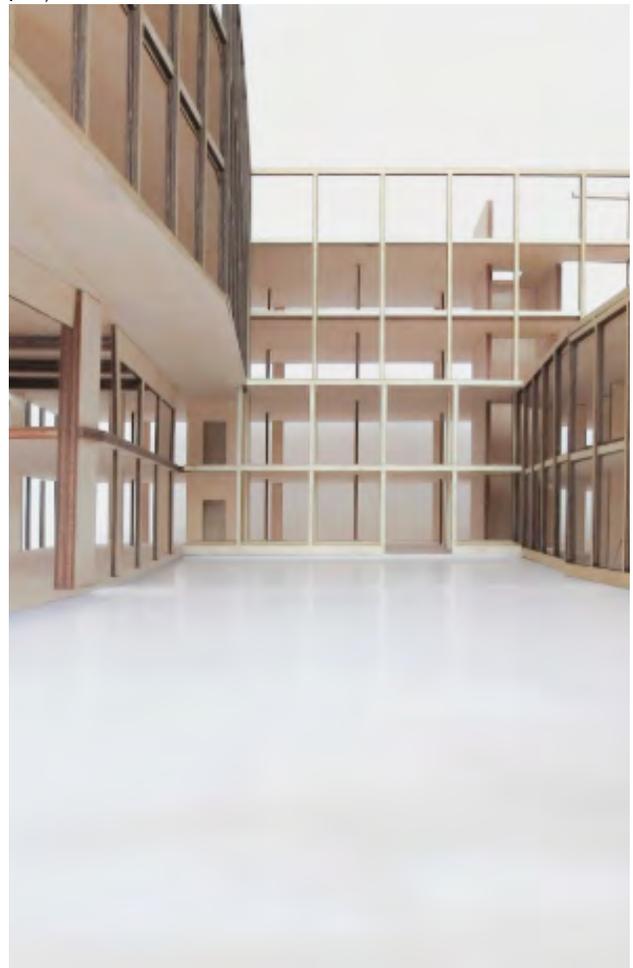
Almshouse. Fotografía de la maqueta del proyecto. Vista interior del Patio Jardín.
